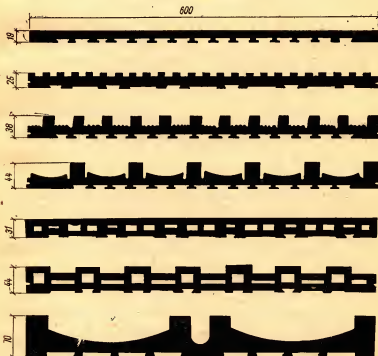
Типы экструзионных плит для отделки фасадов зданий и сооружений фирмы «Johns — Manville»
